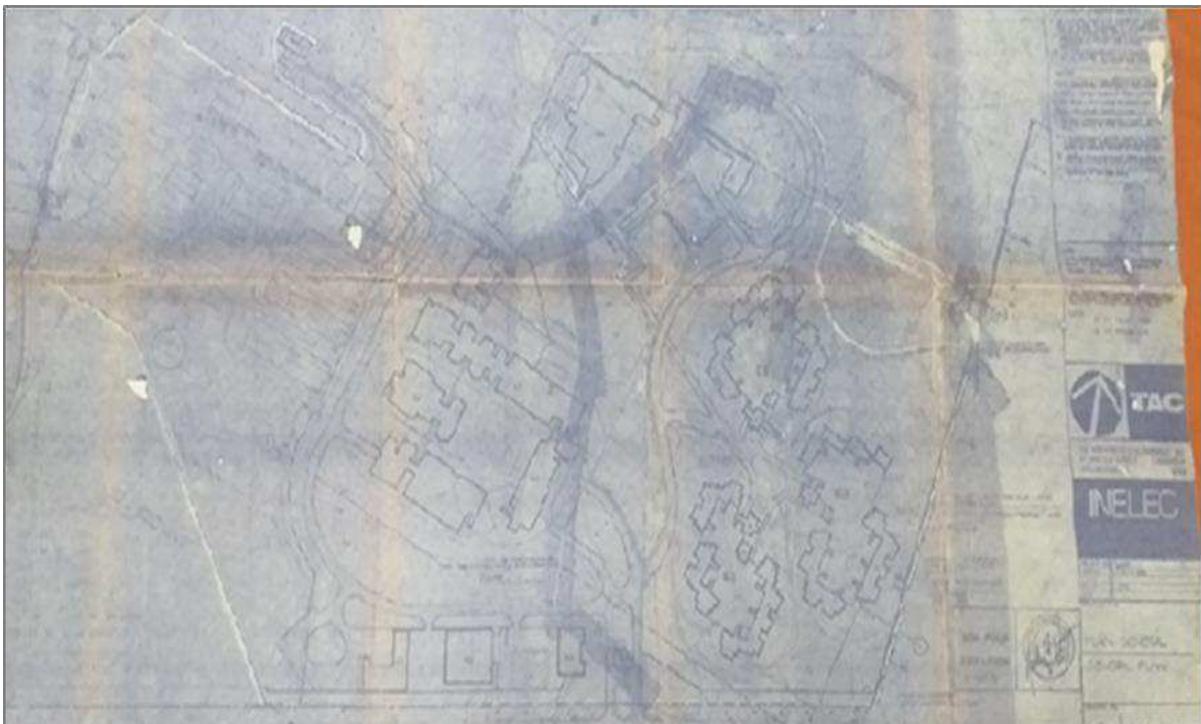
Plan architectural général fait en 1979 par [The architectes collaborative INC]
